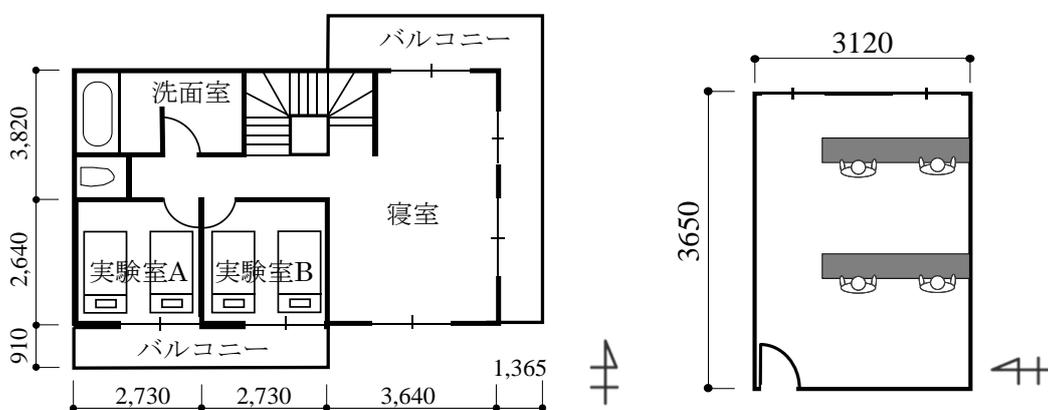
実験場所の平面図 (左：モデル住宅 2 階 右：会議室)
